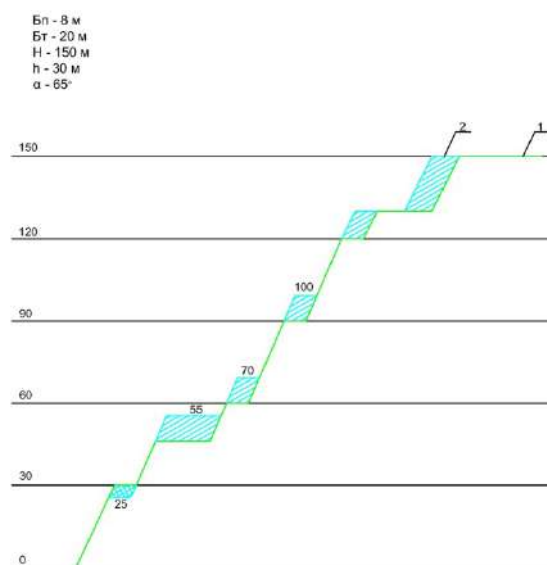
Профили борта карьера: 1- карьер с горизонтальными бортами; 2- карьер с наклонными бермами
